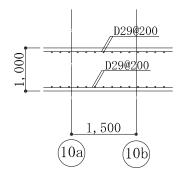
基礎スラブの配筋図 (1A 通り,単位:mm)
